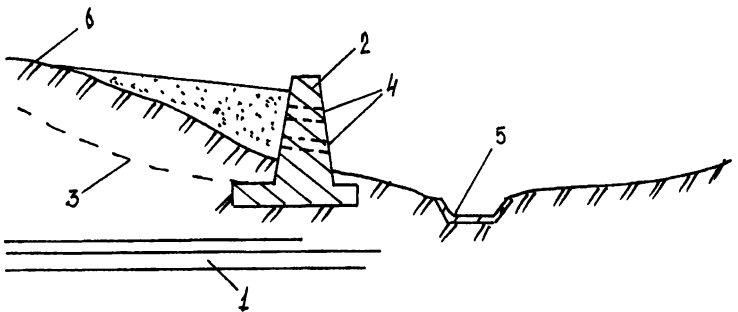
Схема крепления склона консольной подпорной стенкой:
